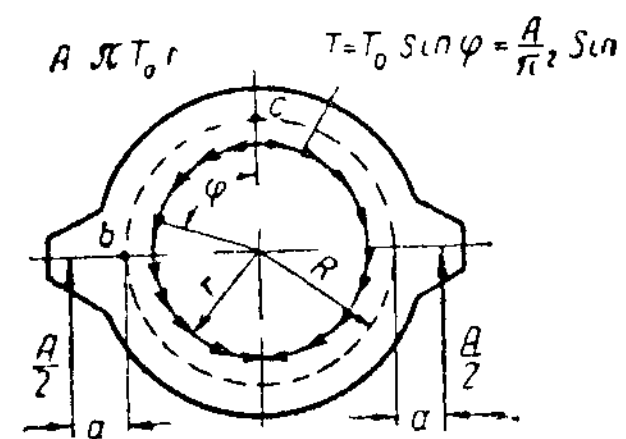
Расчетная схема опорного кольца наземного трубопровода
